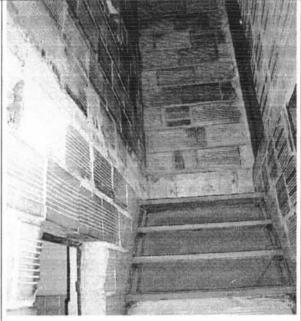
Acceso a mezanine ubicado en la parte posterior del inmueble.
